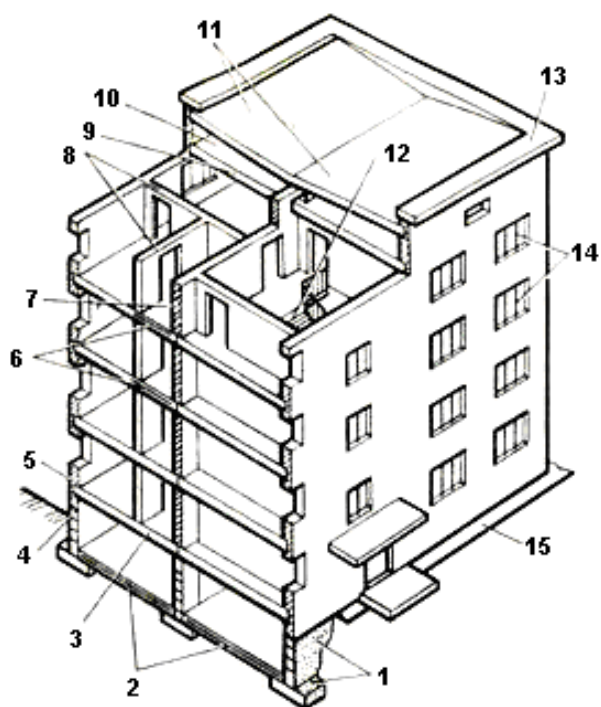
Конструктивная схема многоэтажного здания: 1 – фундамент, 2 – пол подвала, 3 – перекрытие над подвалом, 4 – гидроизоляция, 5 – наружные стены, 6 – междуэтажные перекрытия, 7 – внутренние стены, 8 – перегородки, 9 – чердачное перекрытие, 10 – чердак, 11 – крыша, 12 – лестница, 13 – парапет, 14 – окна, 15 – отмостка
